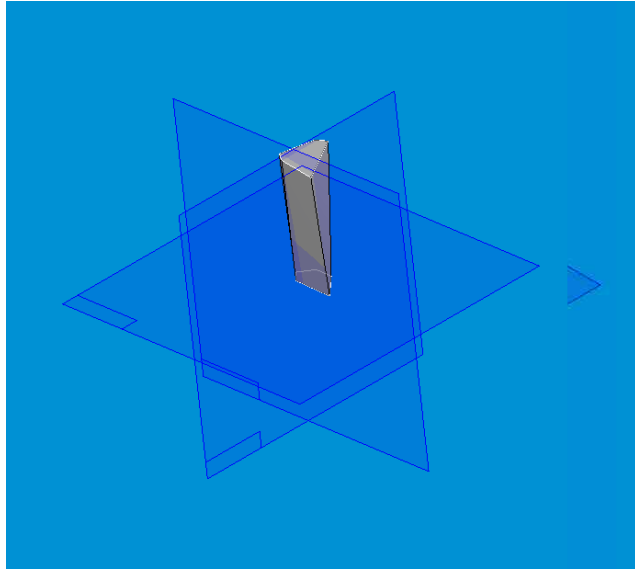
Ricostruzione geometrica del pilastro 21.
